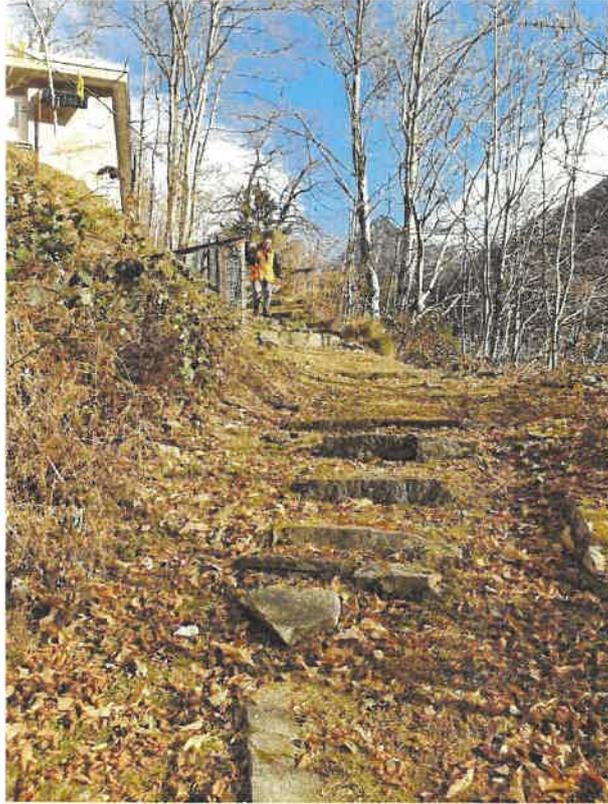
Sentiero di collegamento al serbatoio AP
